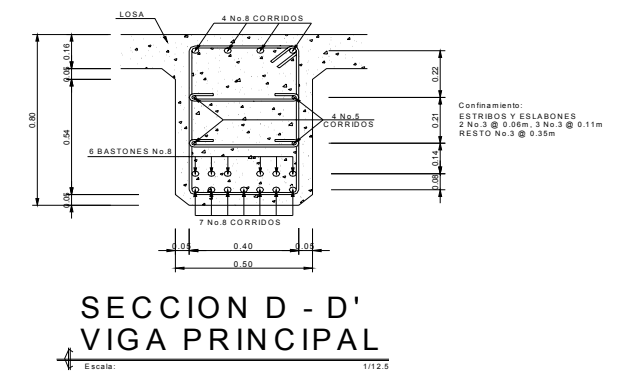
Plano de detalles de vigas principales, cortina y viga de apoyo
